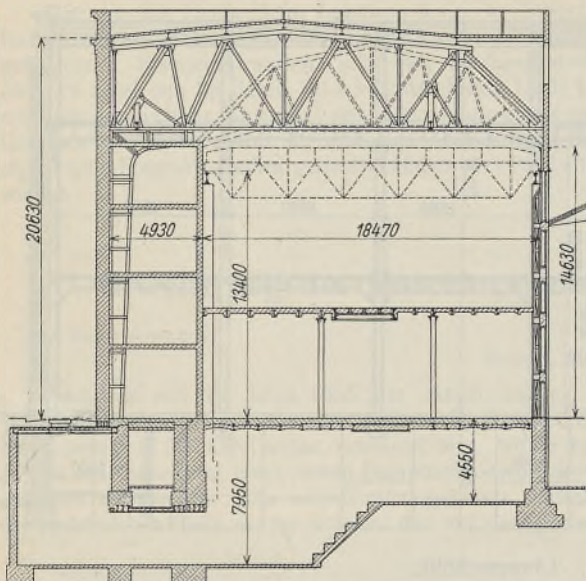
Querschnitt a—b (s. Abb. 3) mit Anschlußbinder.
